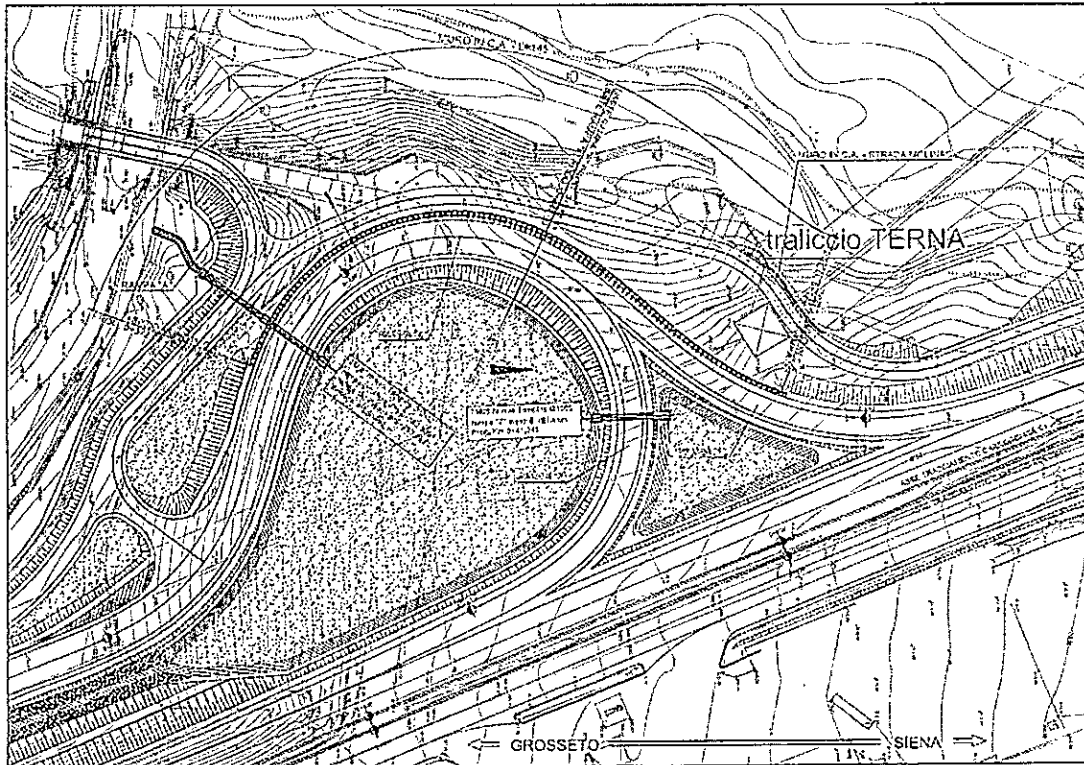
Stralcio planimetrico – Proposta di variante muro in c.a. prefabbricato MU 23
